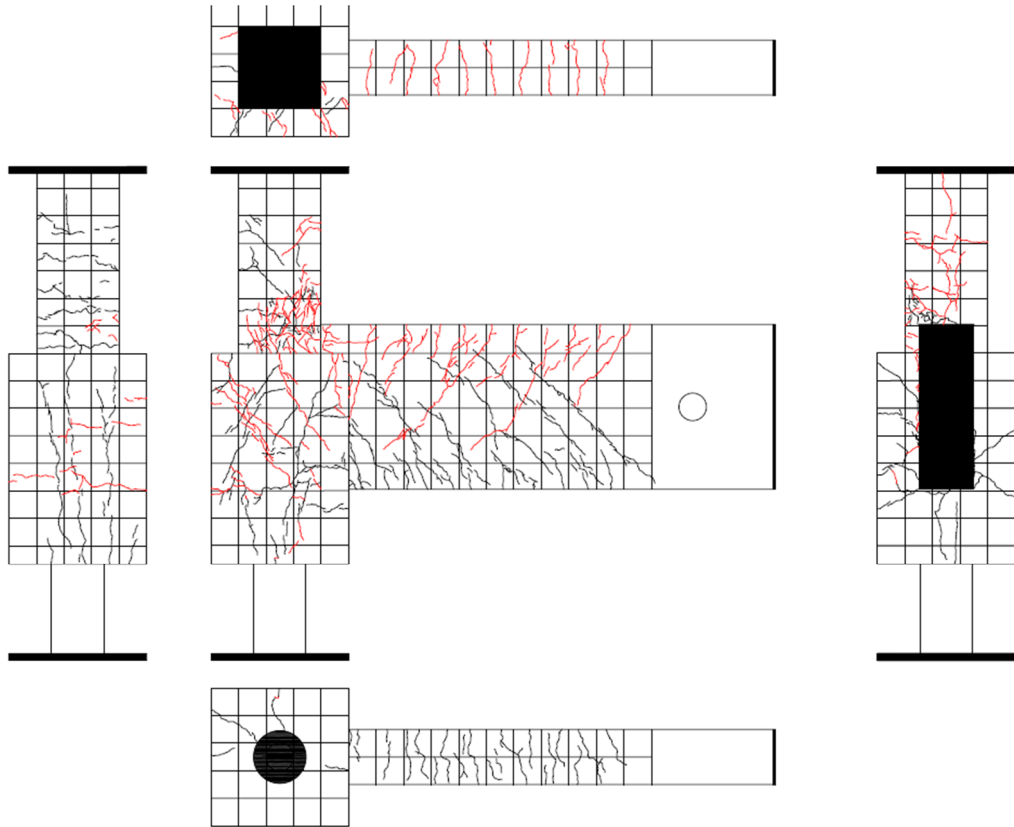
試験体 D-3 ひび割れ状況 (6Cycle)
